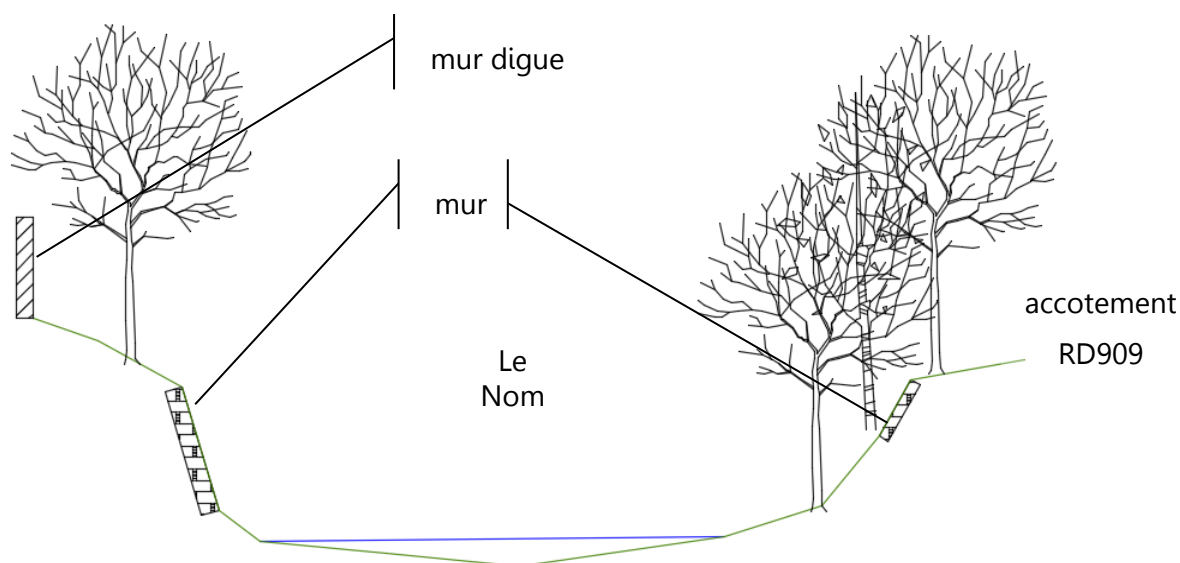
Section type du lit mineur du Nom au droit du site d'étude
